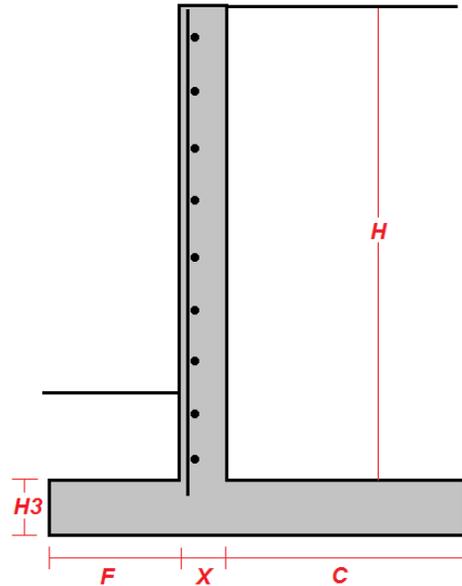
Colocación del acero del vástago para un muro articulado-articulado.
